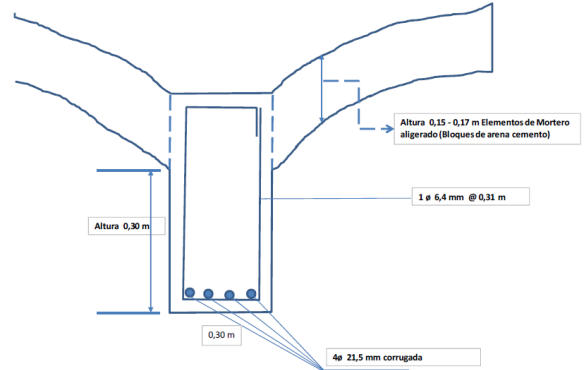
Viga C entre Ejes 6-7 Quinto Piso Cuarta Placa
